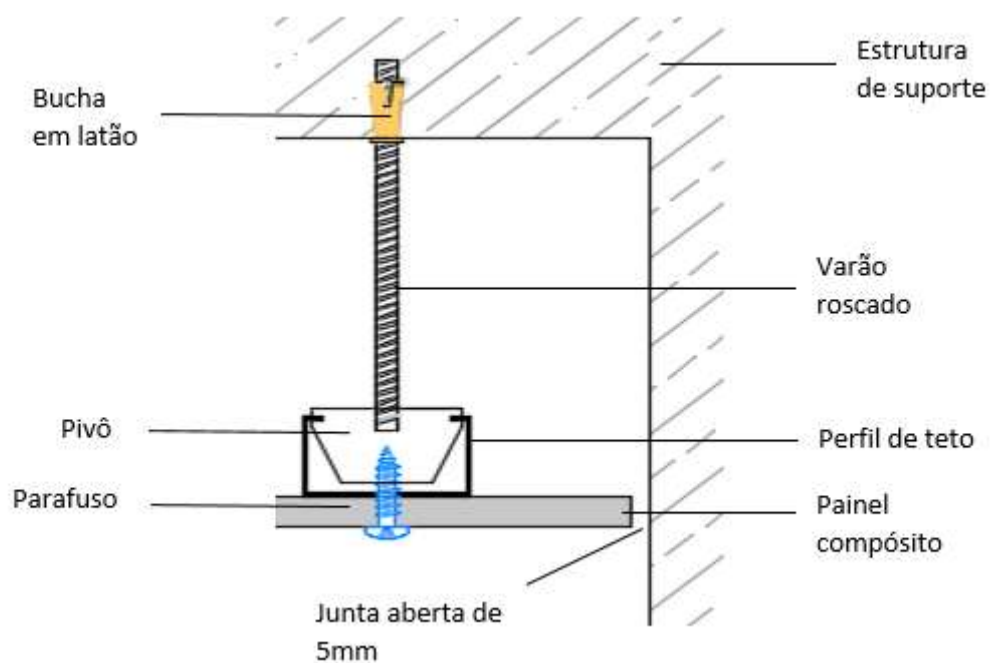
Pormenor transversal na aplicação em tetos falsos
